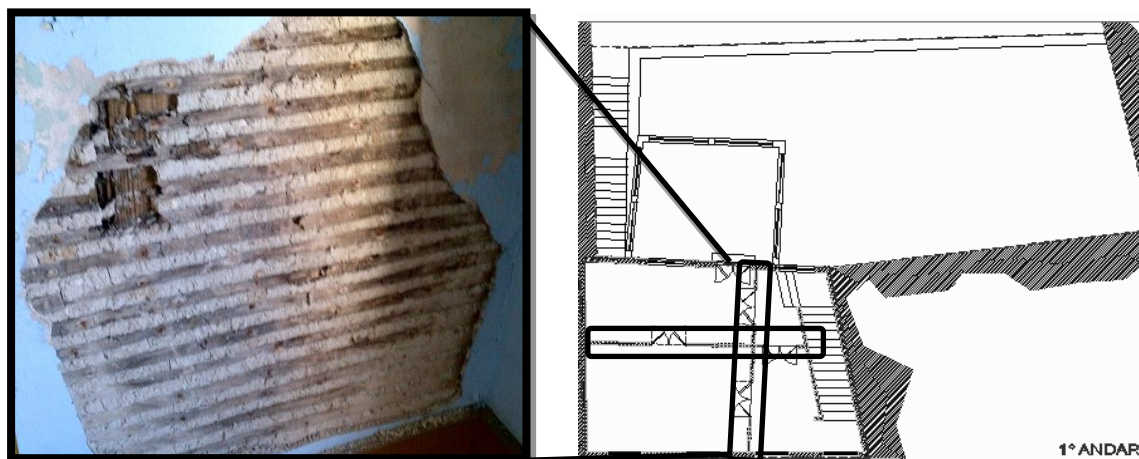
Anomalia 13 - Fotografia e localização em planta.
